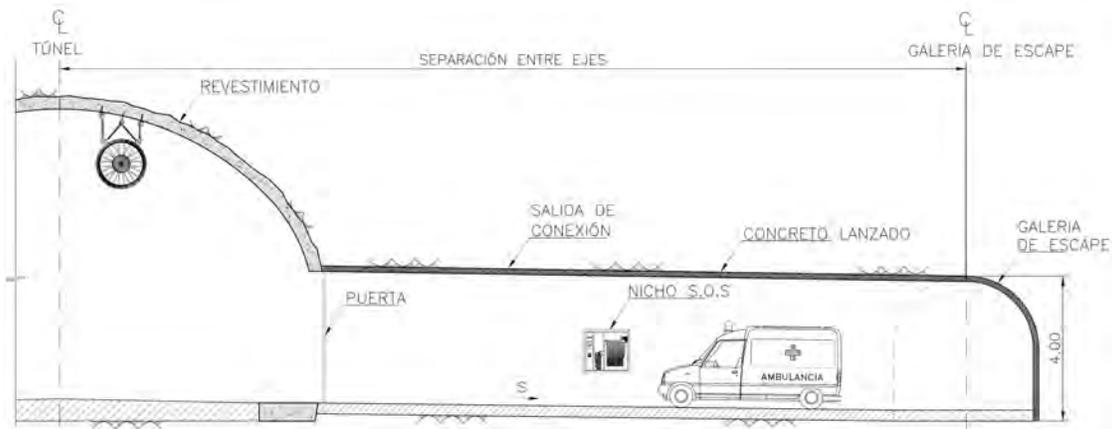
Sección tipo de galería de conexión en túnel con galería de escape.
